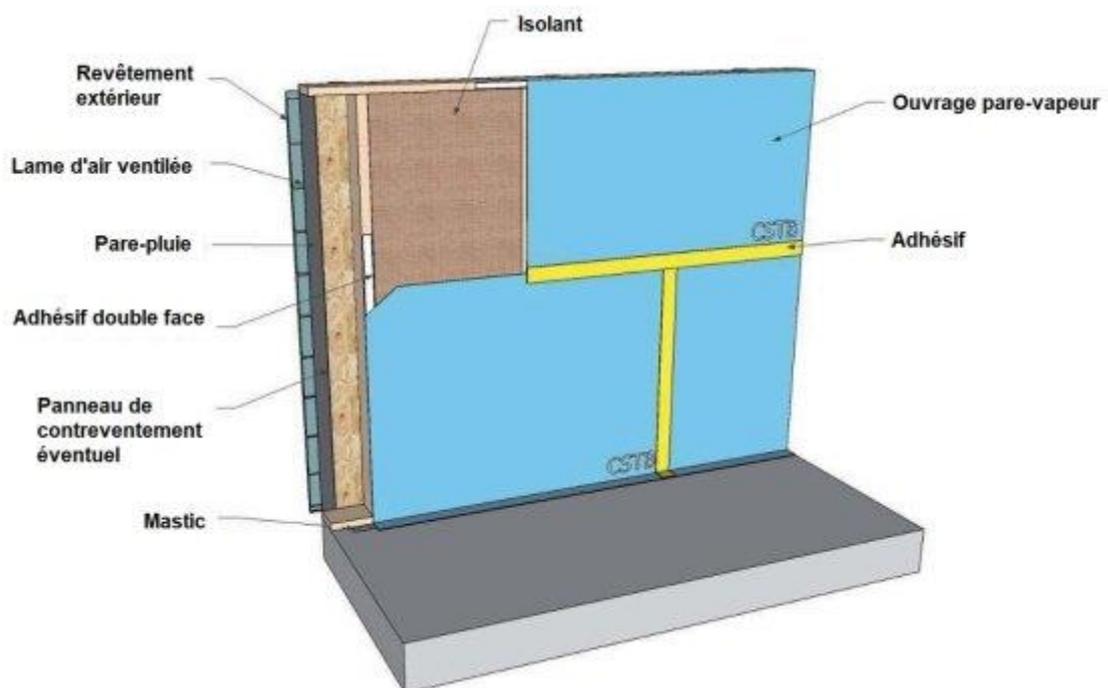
bis – Pose de l'ouvrage pare-vapeur en isolation intérieure de mur de construction à ossature bois
